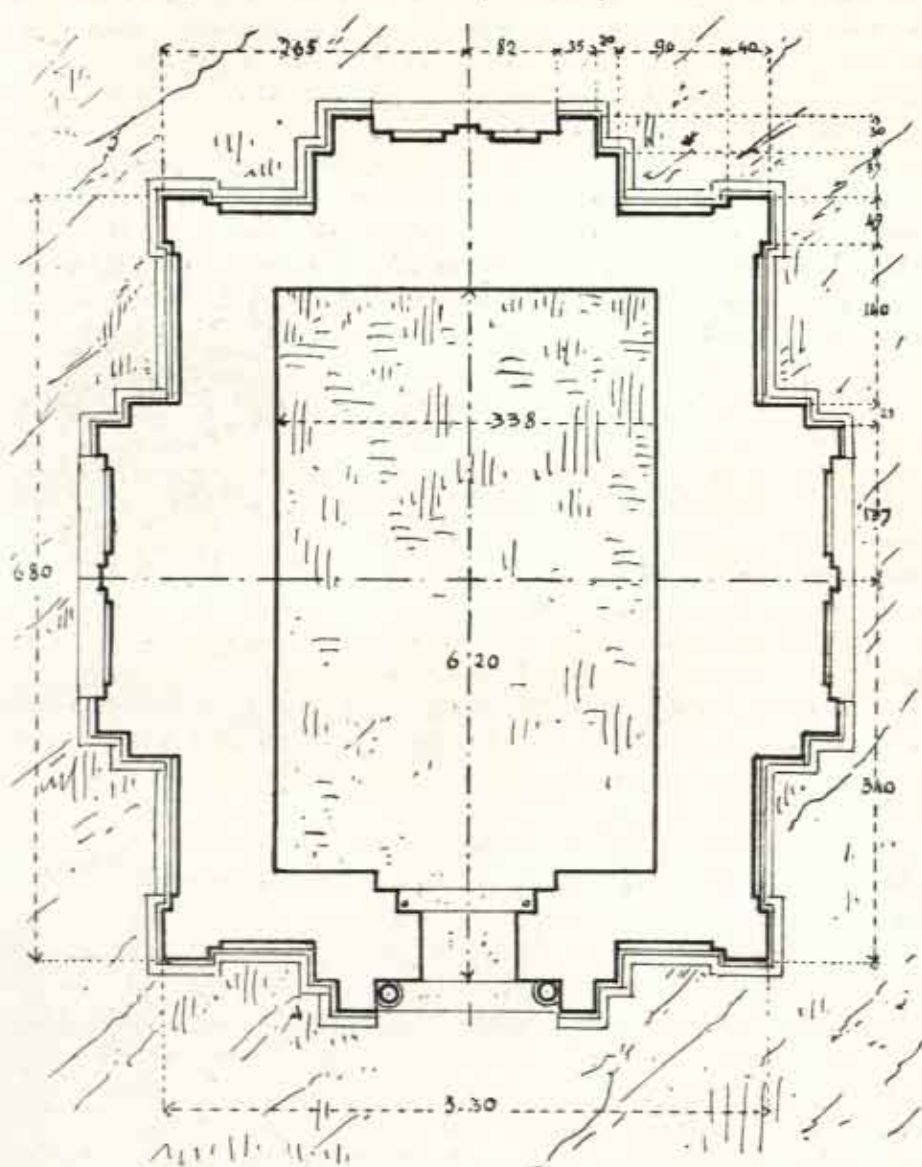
PRASAT TRAPĀN PRŌṆ. Tour centrale. Plan.
